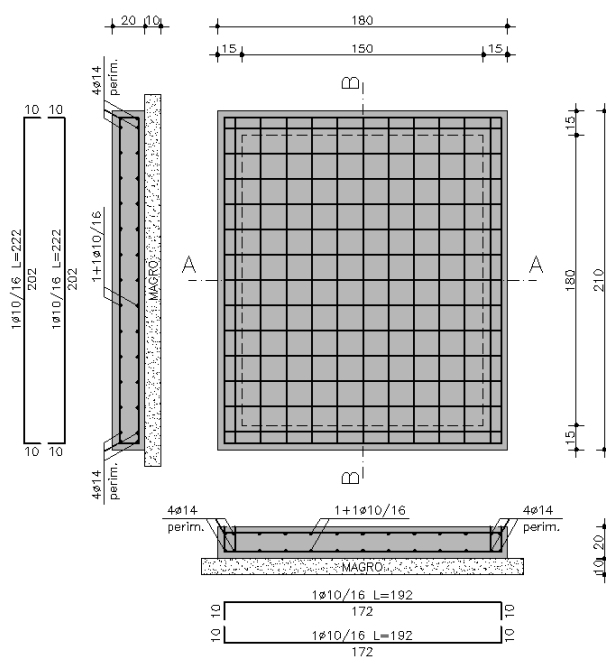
Pozzetto n. 2 - Sezione sul fondo
